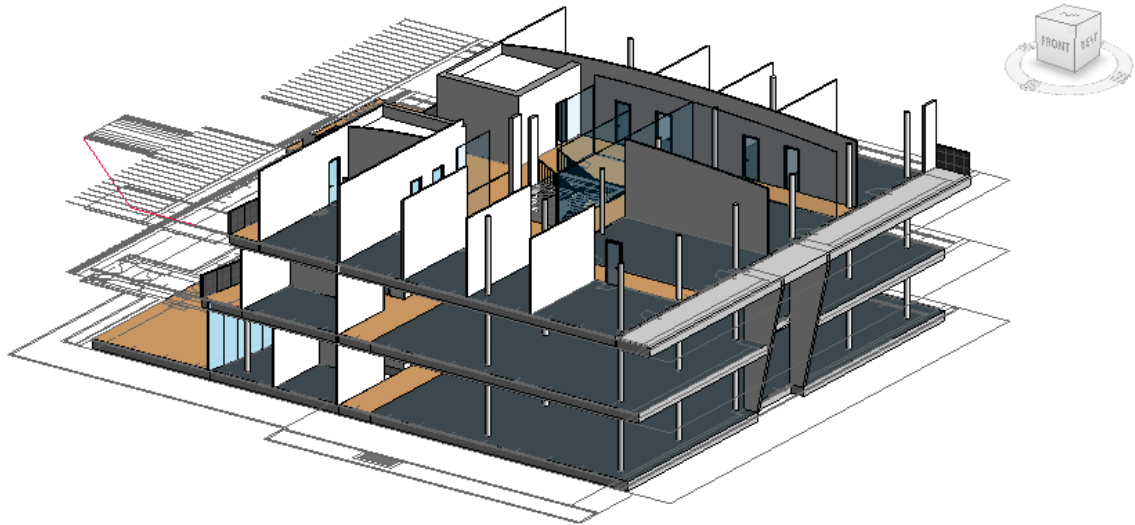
6 Prospetto nord-ovest dell'edificio modellato in Revit
